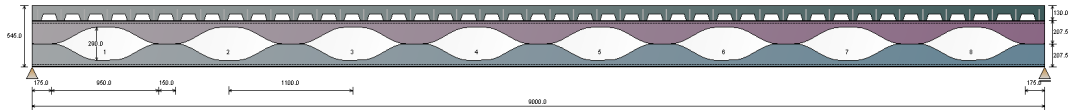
Geometria de la viga ANGELINA™ compuesta
